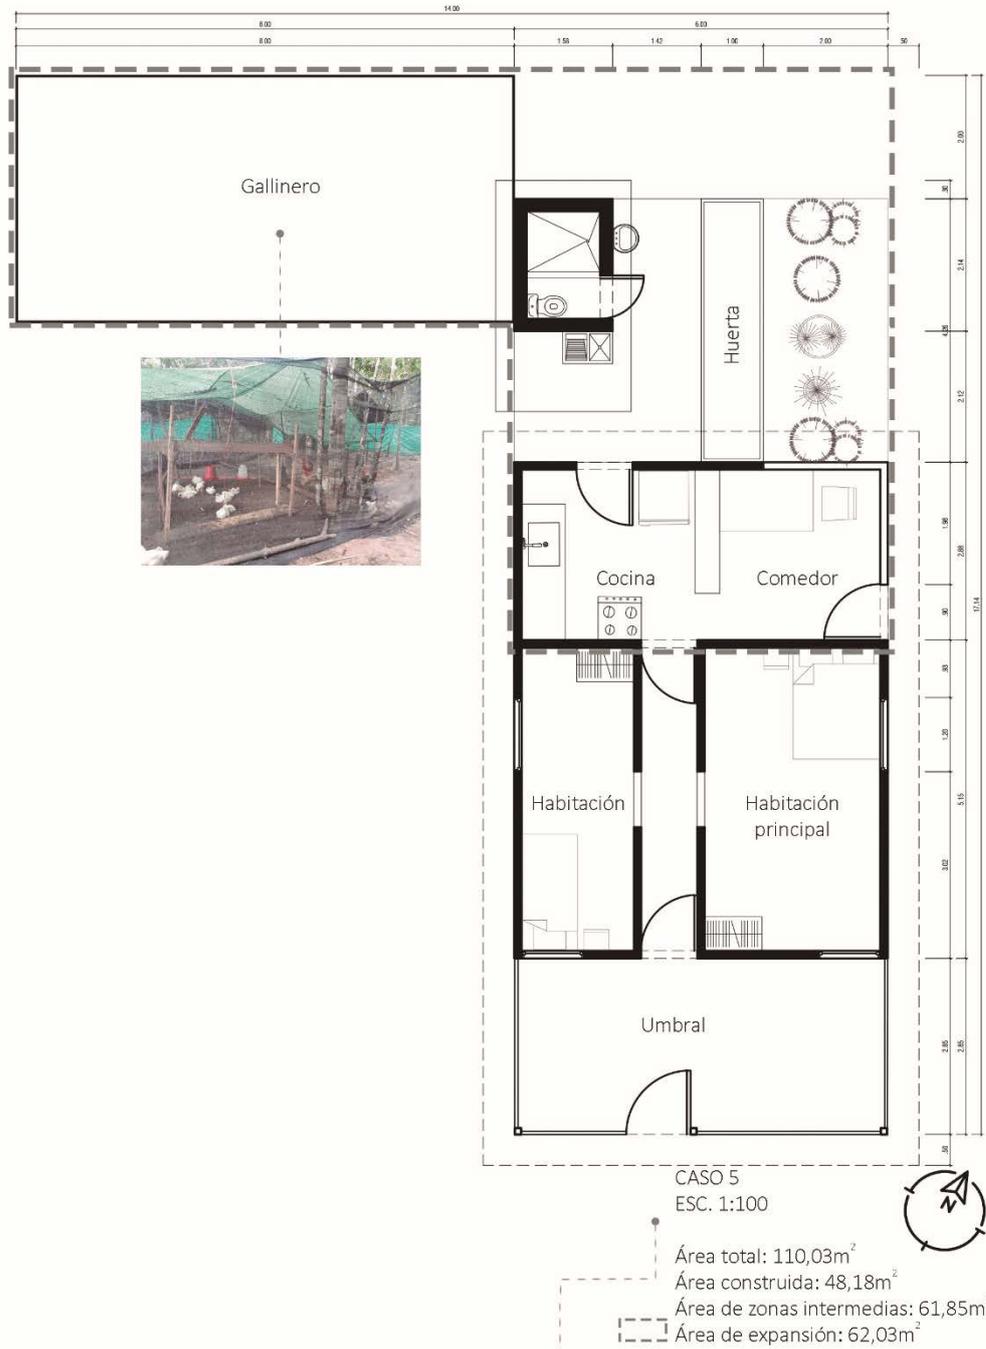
Planta caso 5. Esc. 1: 100. Fuente: Elaboración propia, con soporte en levantamiento planimétrico, (ETCR "Jaime Pardo Leal", San José del Guaviare, 5 ago. 2018)
